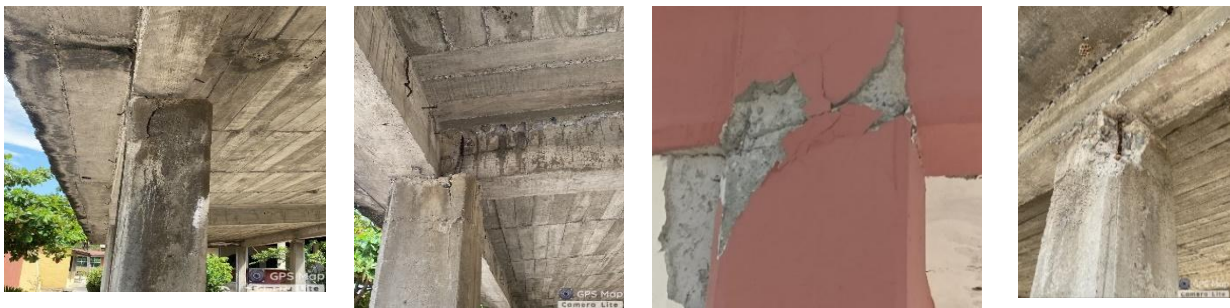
Deficiencias en el armado en la región de la conexión viga-columna
